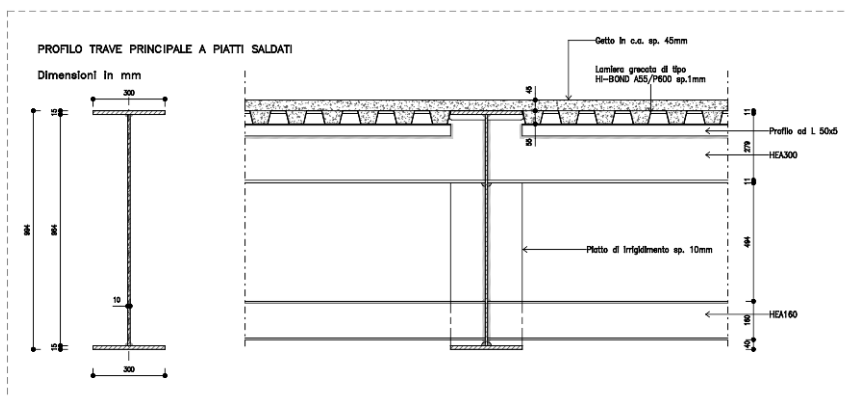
Messa in opera del pacchetto strutturale punti 1-2-3
